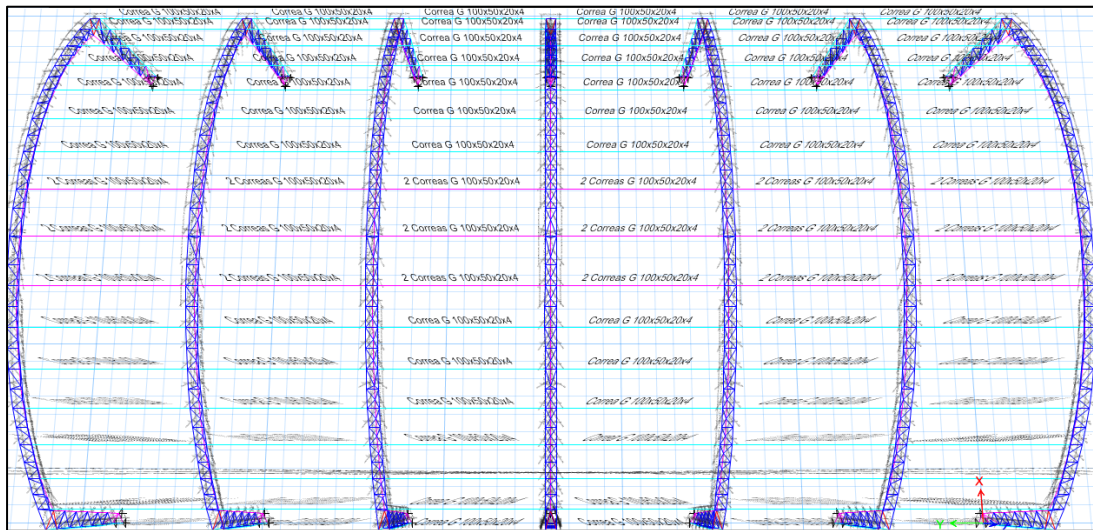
Detalle diagonales en la unión cercha - columna.
